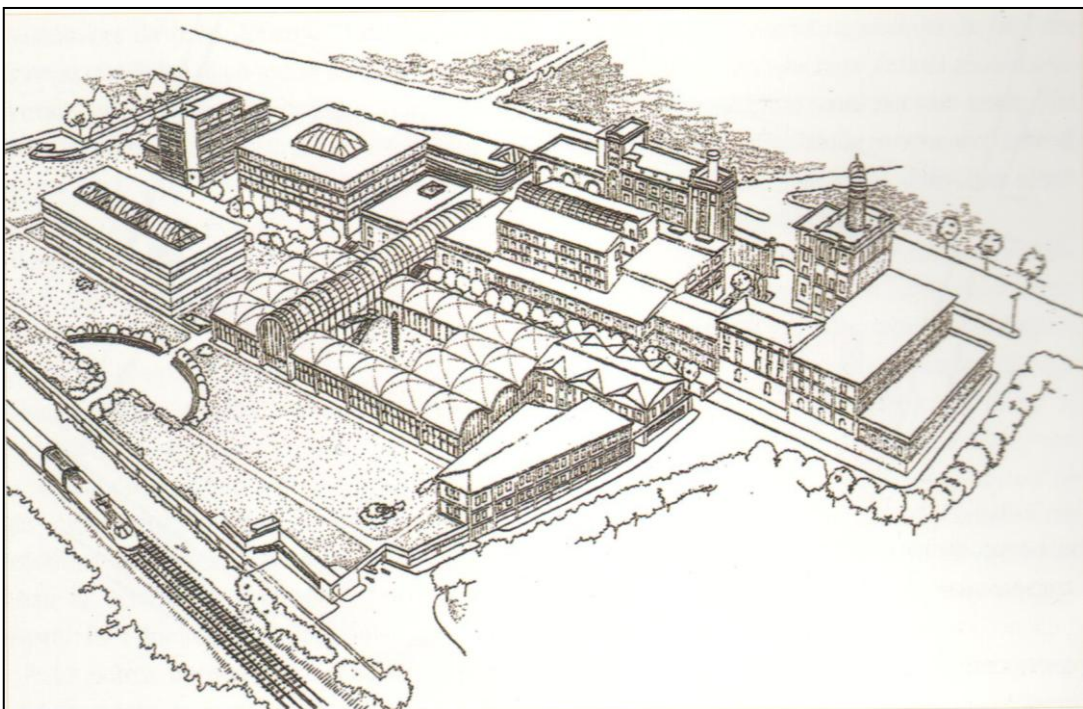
Progetto preliminare. Veduta dall'alto dello stato finale.
